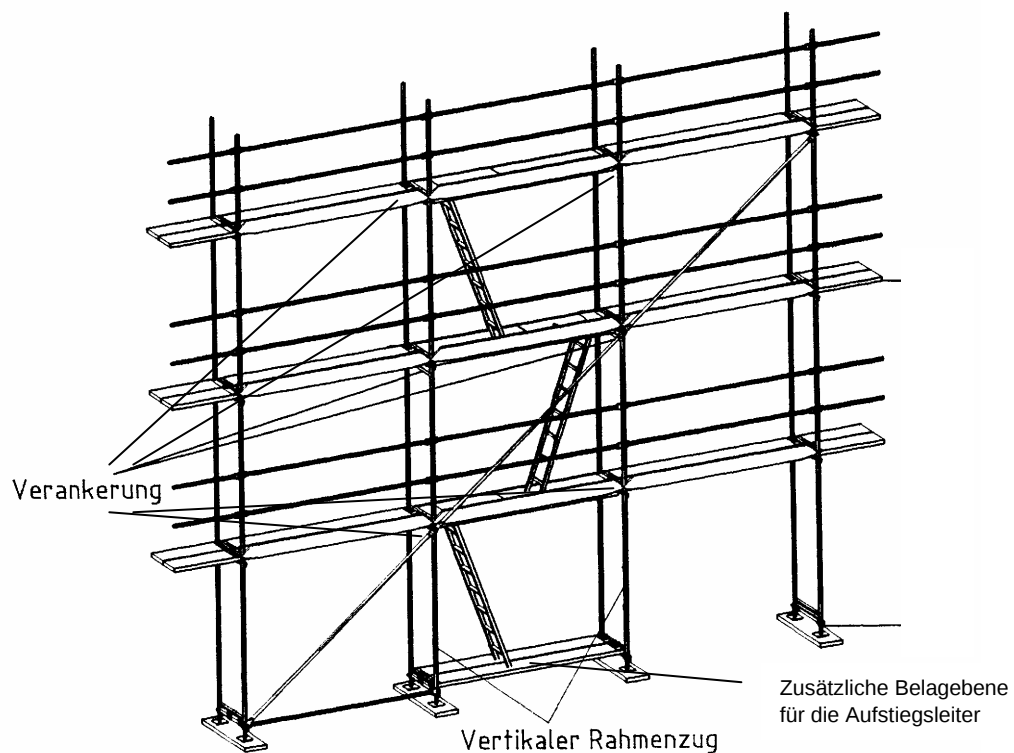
Gerüstfeld mit innenliegendem Leitergang
